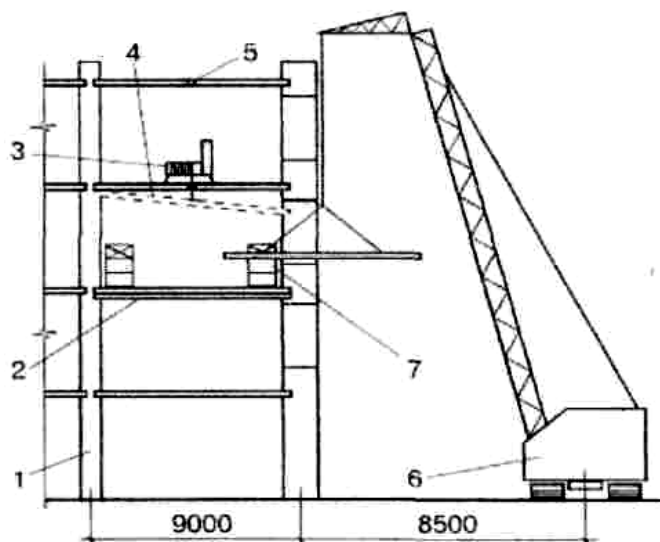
Схема виробництва робіт по підсиленню залізобетонних перекриттів: 1 – існуюча будівля; 2 – змонтована балка; 3 – ручна лебідка; 4 – балка посилення, що монтується; 5 – отворів для пропуску тросу лебідки; 6 – гусеничний край; 7 – інвентарні підмости
